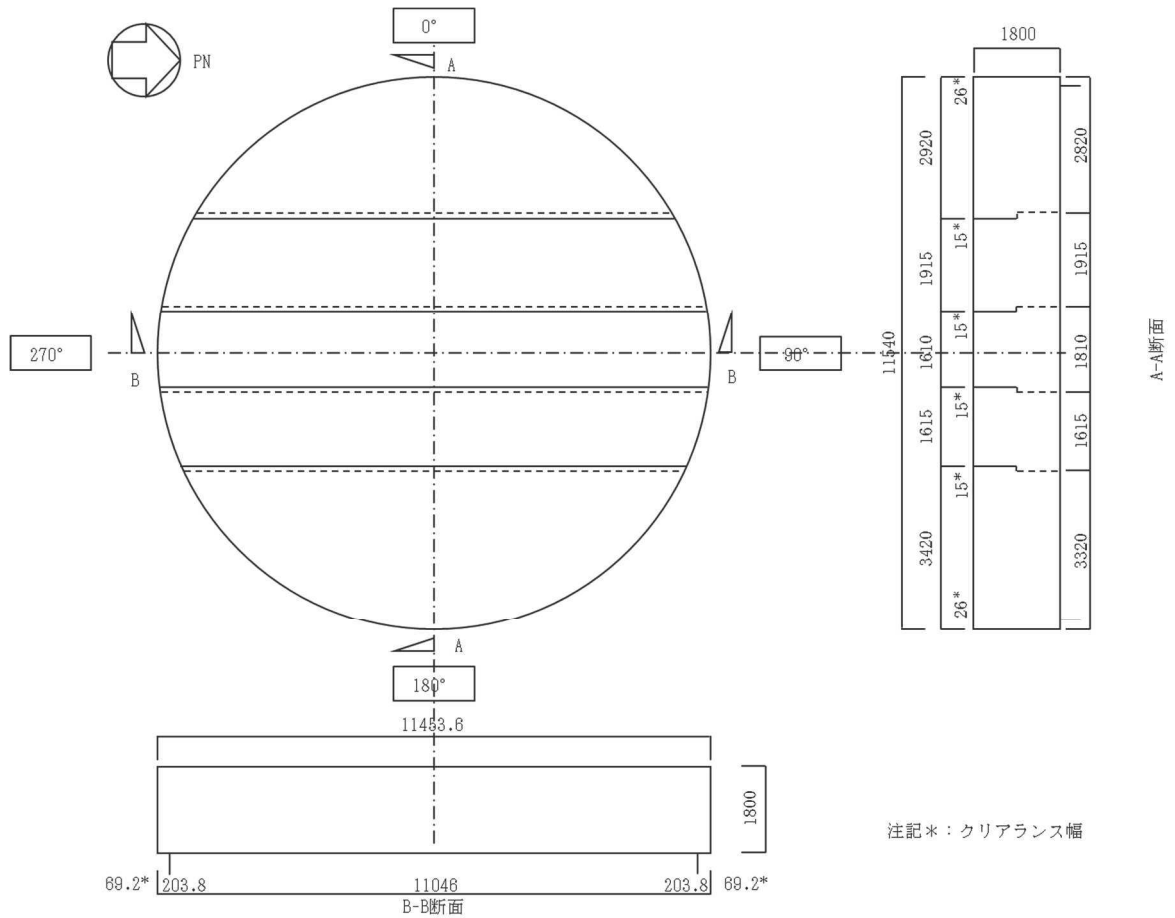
原子炉ウェルカバー概要図(単位 : mm)
